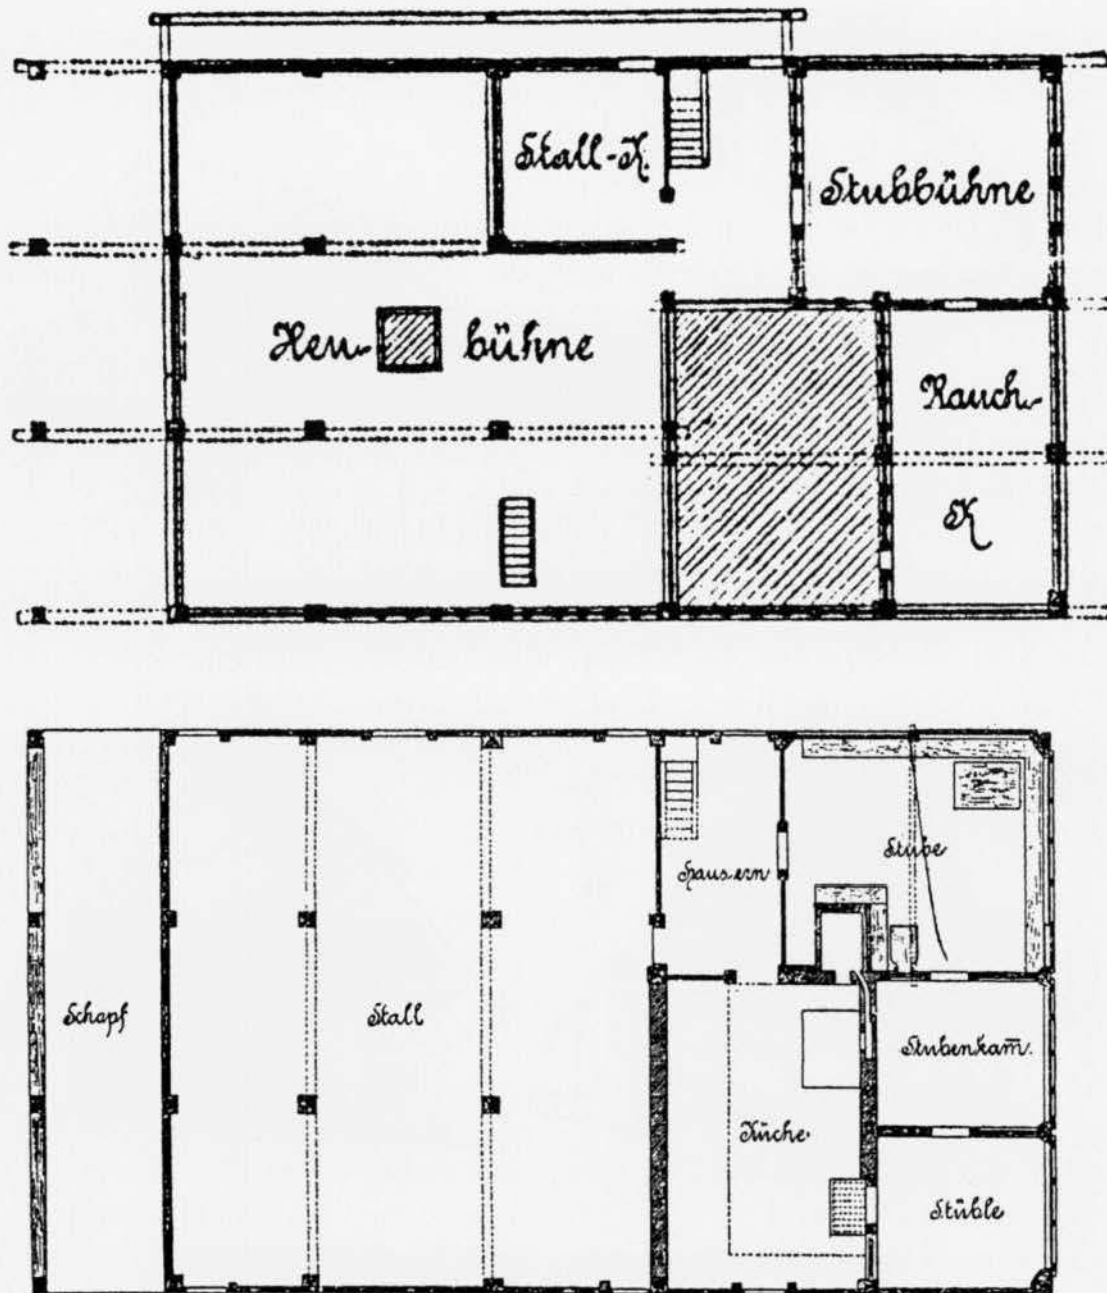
Grundrisse vom Erd- und Obergeschoss des um 1759 erbauten und 1902/03 abgebrannten Laublehofs in Gutach nach einer von Carl Schäfer um 1890 durchgeführten Bestandsaufnahme (siehe auch Bild 10a).
